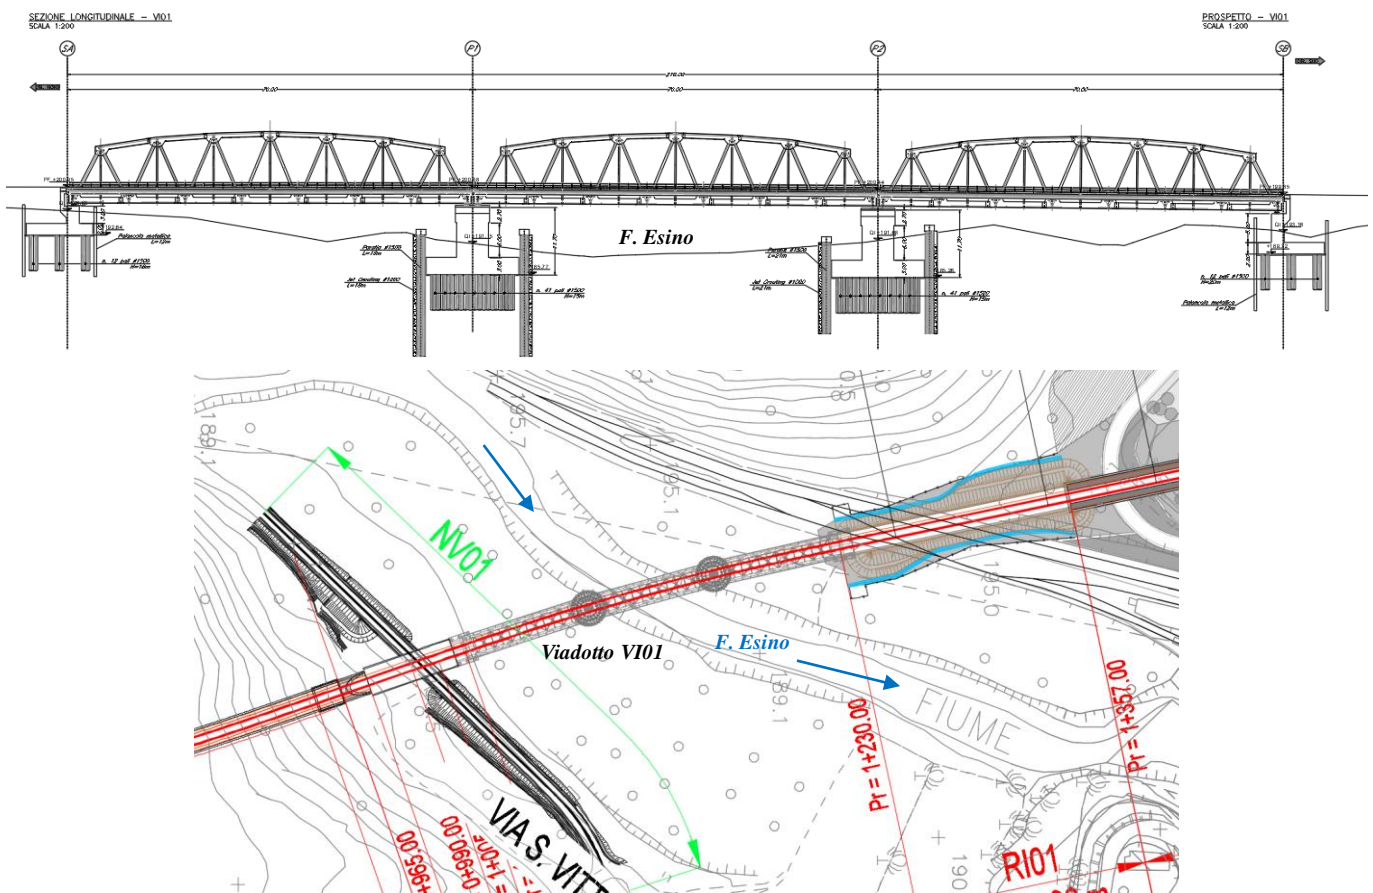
Viadotto VI01 sul Fiume Esino: prospetto (sopra) e pianta (sotto).
